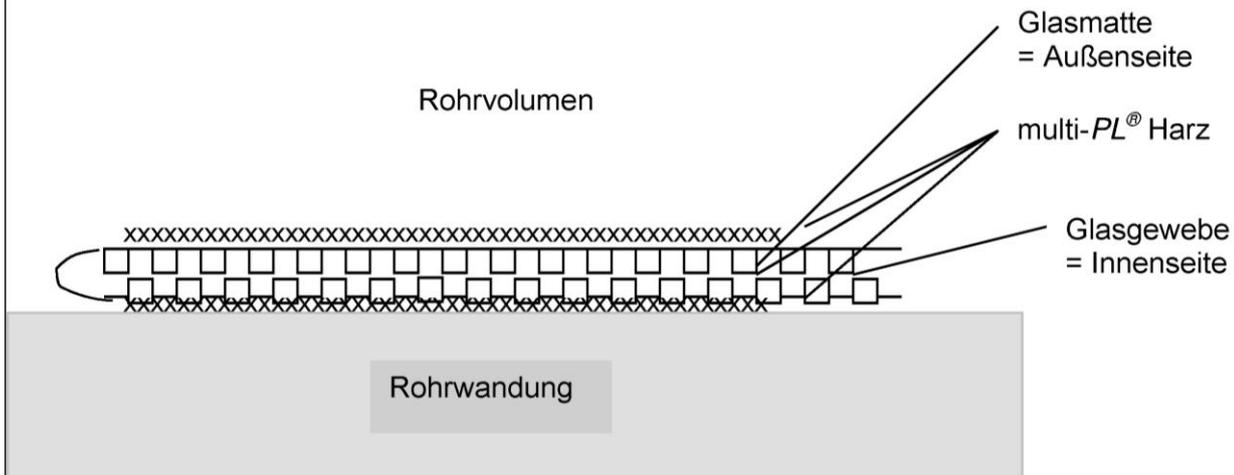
Schema Wandaufbau *Point Liner*[®], doppellagig
